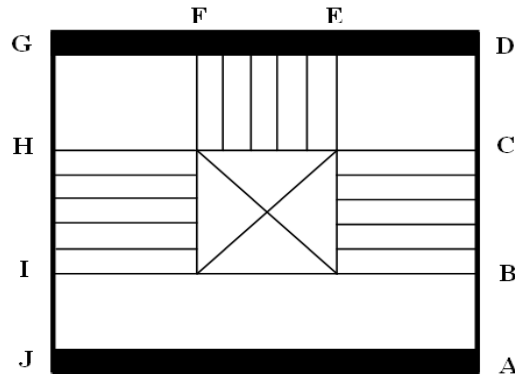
Disposition constructive des armatures de la dalle de compression.
